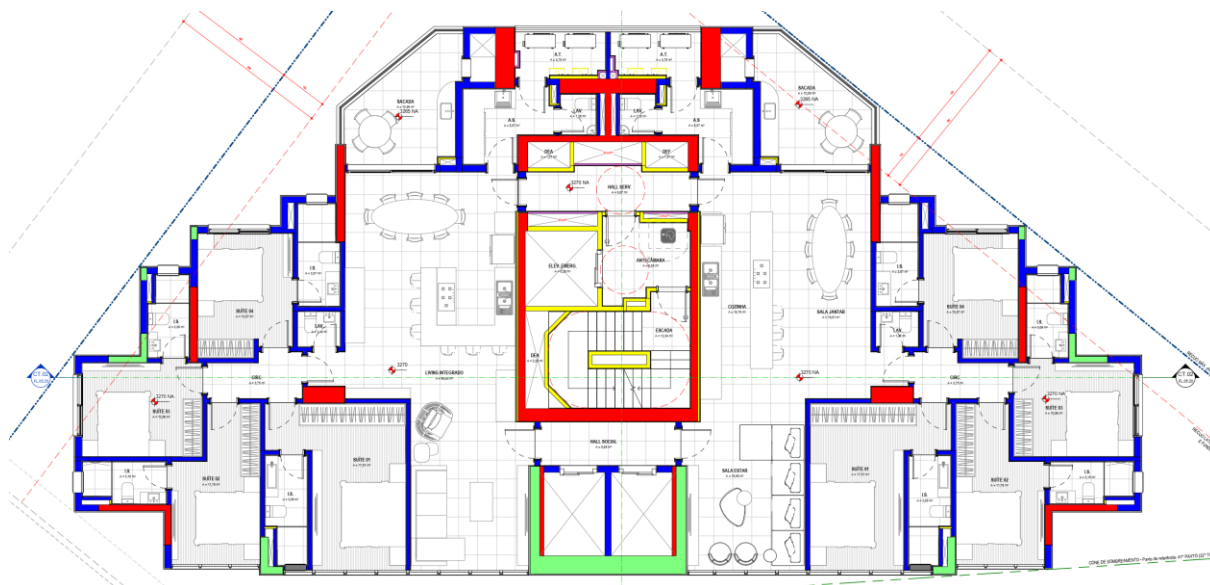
Pavimento 10º - Residencial Tipo 2 ao 15
